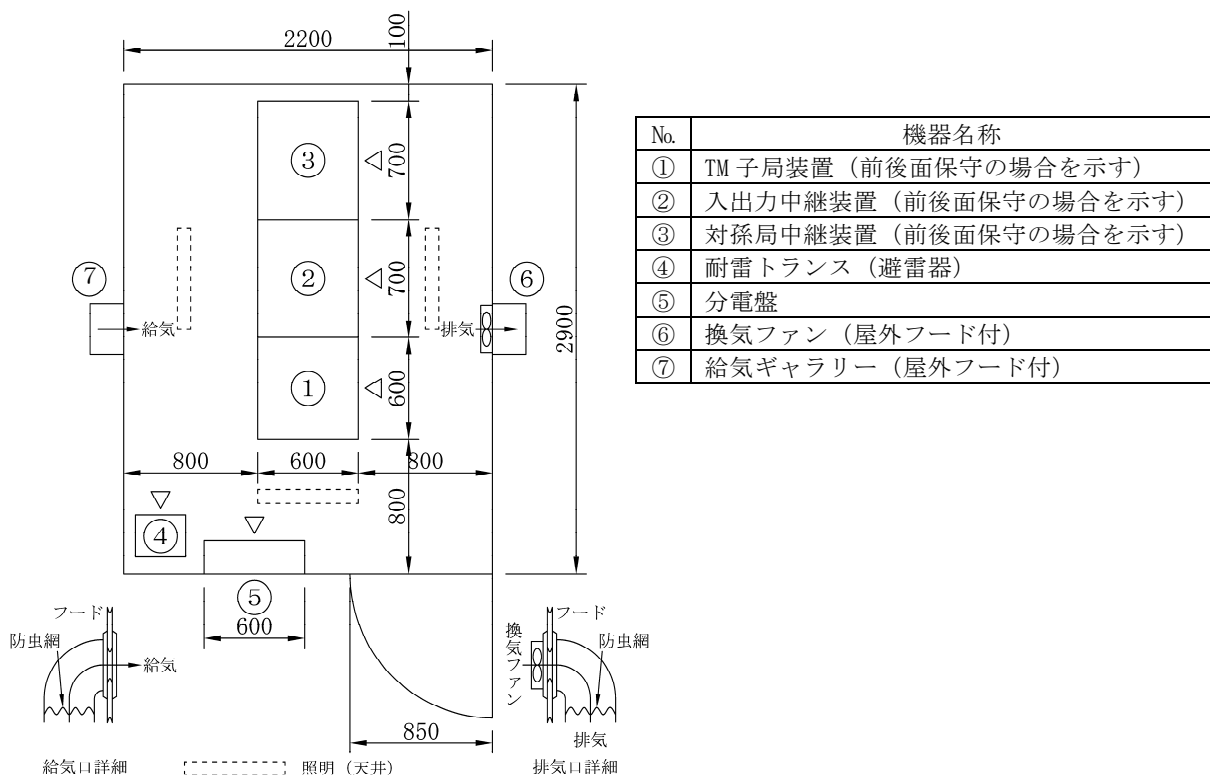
ダム現場管理所 機器配置図（例）（大型表示装置タイプ）
